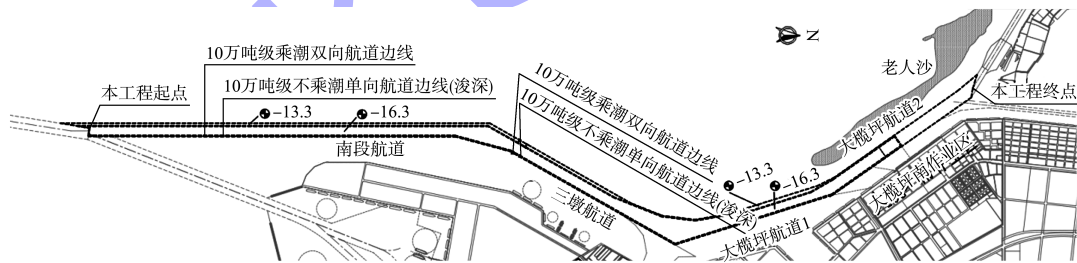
钦州港东航道扩建工程总平面布置(单位: m)
